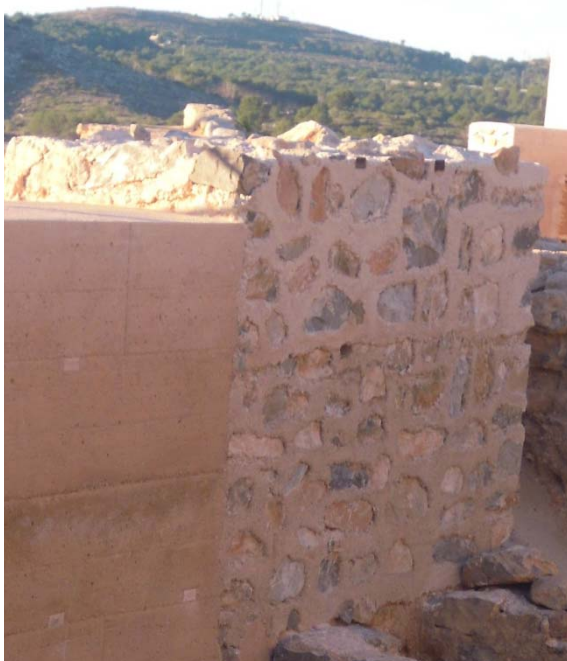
Muro de tapia de mampostería y hormigón de cal
